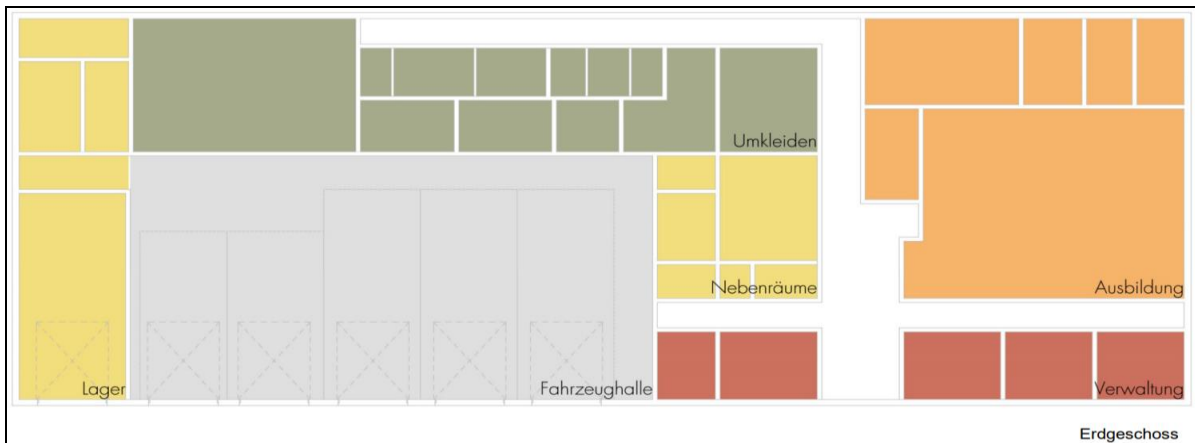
Testgrundriss Stützpunktfeuerwehr in Immensen (Auszug aus der Machbarkeitsstudie, Büro MOSAIK)
